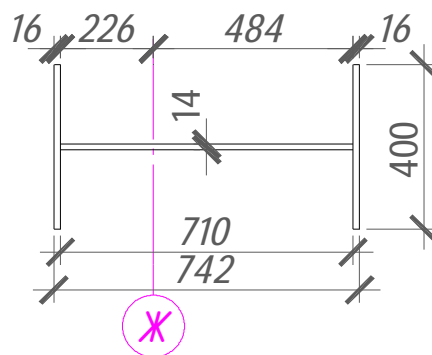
Поперечное сечение надкрановой части колонны по оси «Ж» в отметках 14÷22 м.
